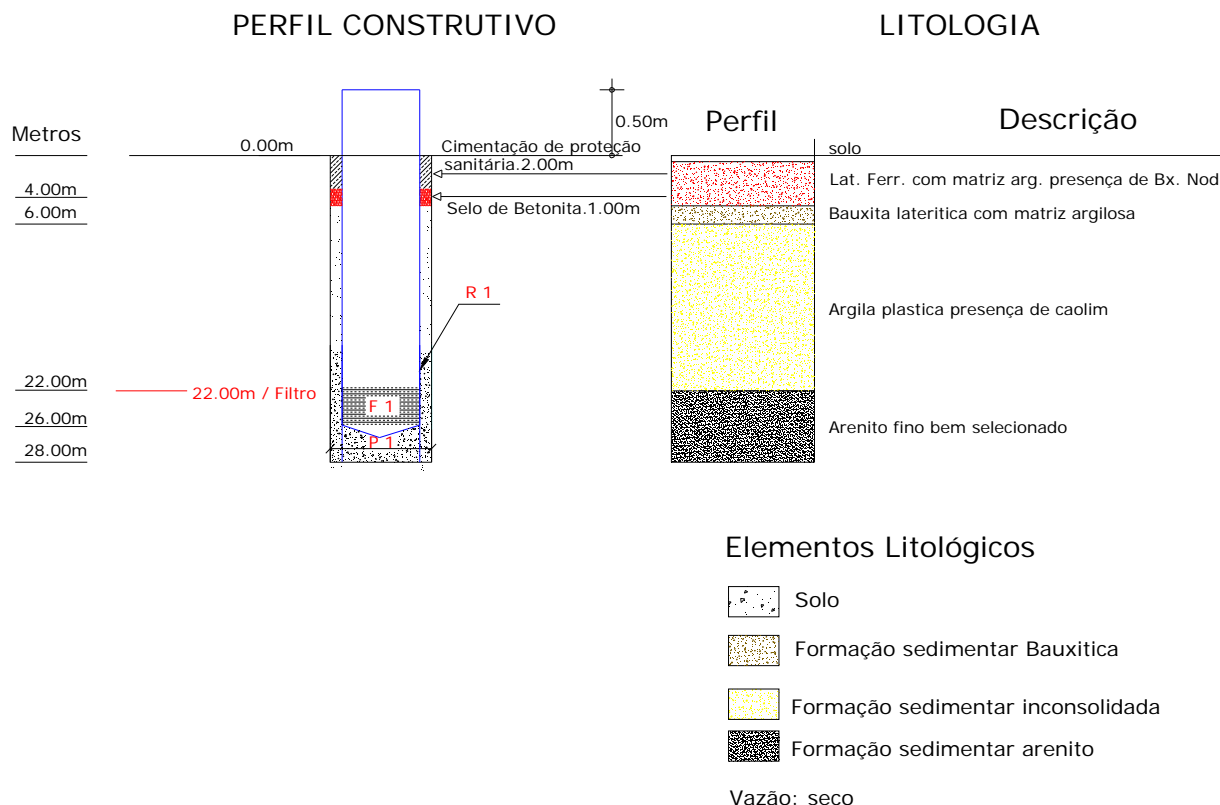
Perfil construtivo esquemático dos piezômetros rasos e em área reflorestada.
